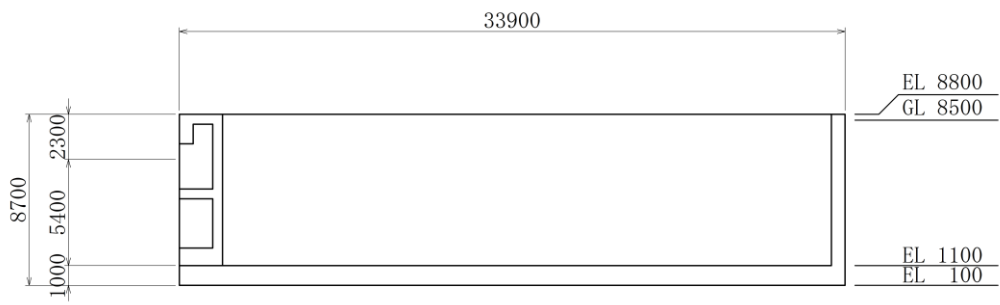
取水槽 断面図(C-C断面) (単位:mm)
